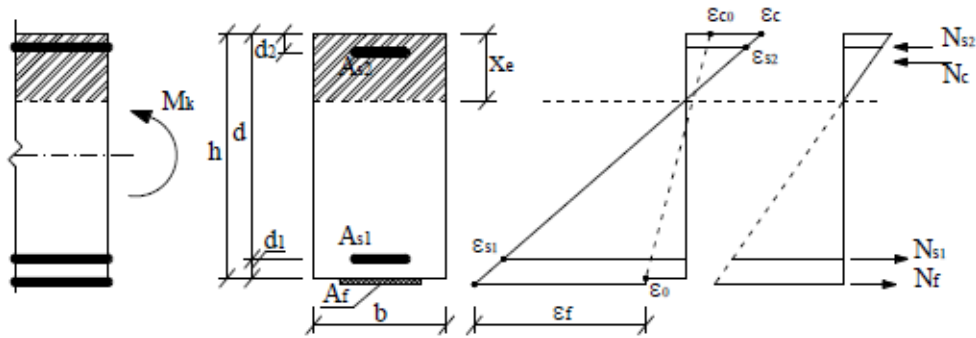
Secção de betão armado reforçada com FRP para ELS
